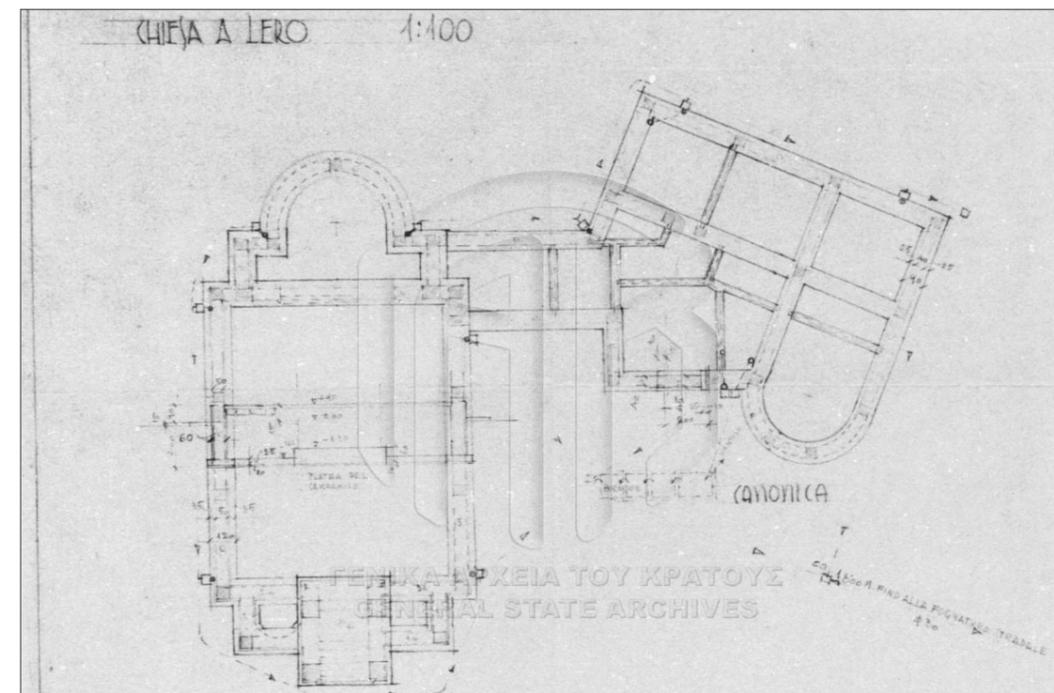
chiesa, pianta delle fondazioni, sc. 1:100
